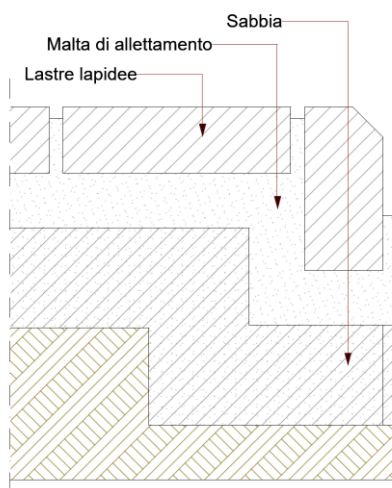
Esempio di pavimentazione carrabile/marciapiede in basolato
